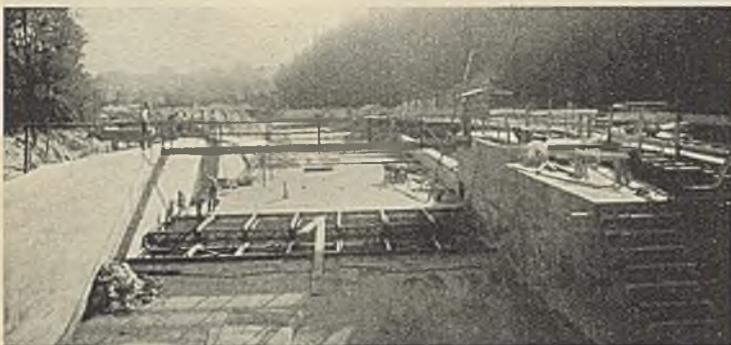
Wehranlage in der Schlierach, Montage des Dachwehres.
